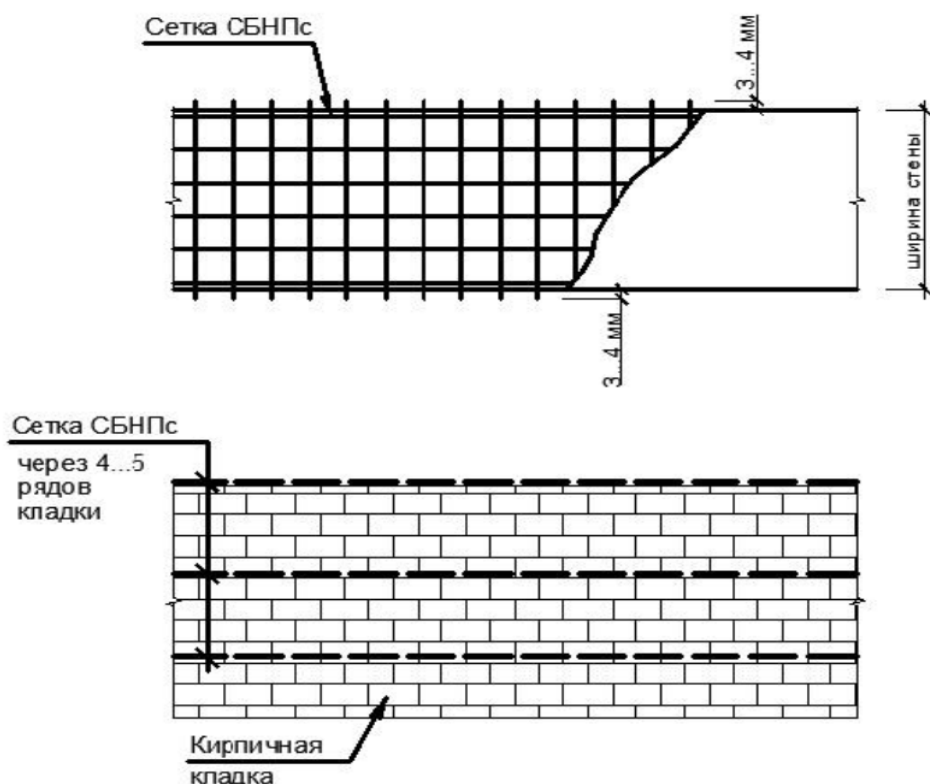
Схема армирования кладки сеткой «Экострой-СБС»
